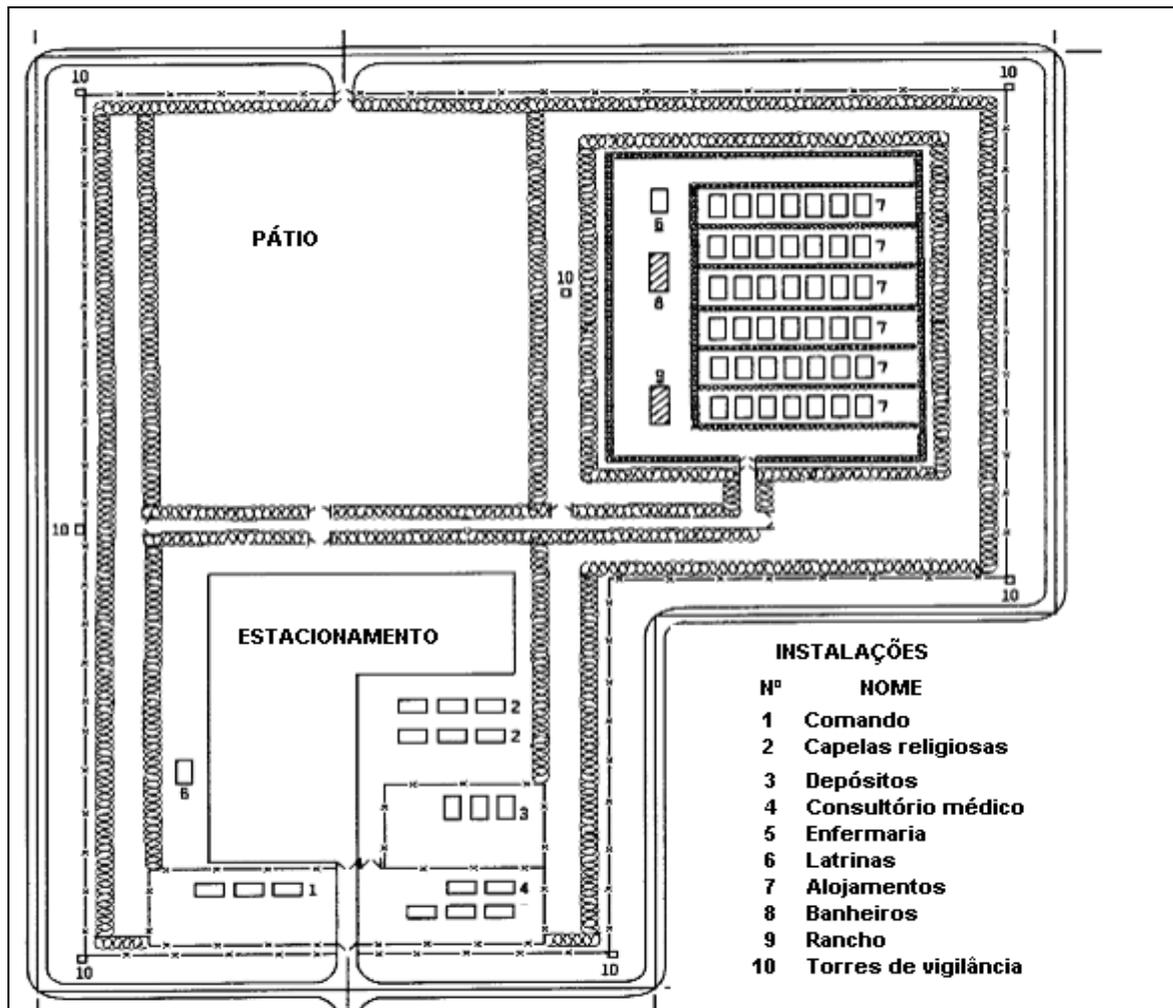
Exemplo de construção de uma instalação para campo de PG
